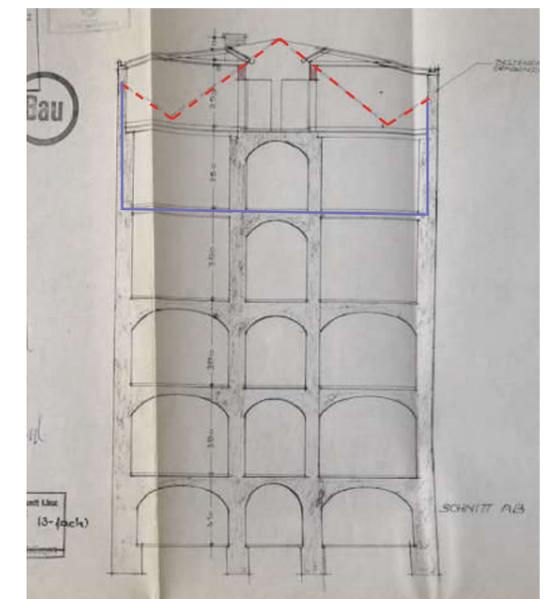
zeigt Einreichplan zum späteren Dachausbau 1988 und das Dach so wie es in der 3. Bauphase ausgeführt wurde (in rot markiert) Geschossausbau in BP 3 lila markiert
